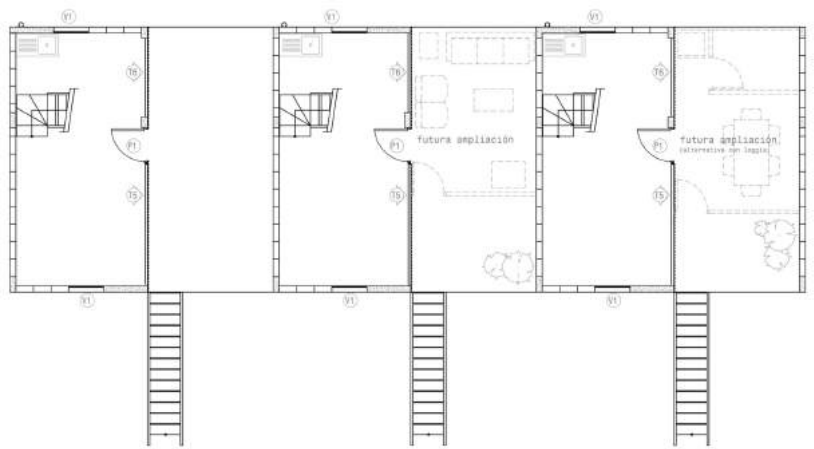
Aravena, Alejandro, ELEMENTAL, Quinta Monroy, Grundriss zweite Ebene, 2003.
